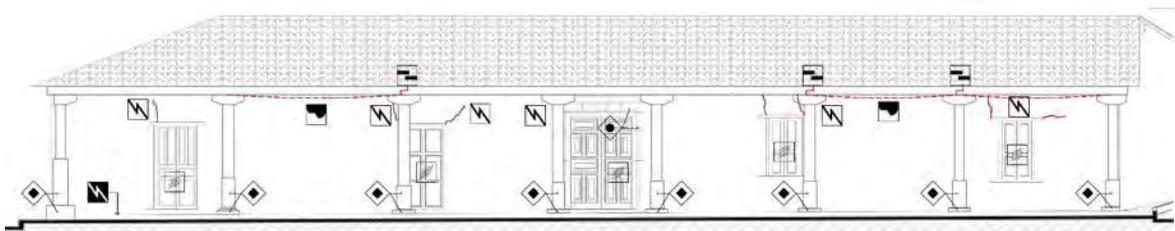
Croquis de fachada poniente; se identifica que las grietas en los elementos de madera, así como la flexión y desensamble de vigas, son los deterioros de mayor presencia. Elaboró: AMT.
